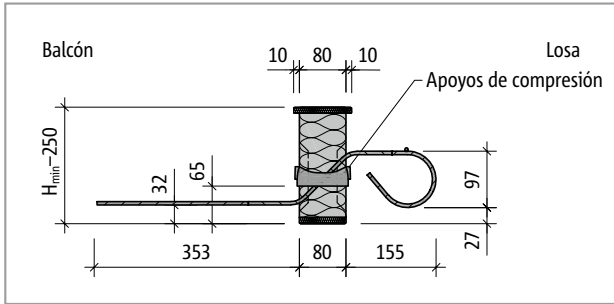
Schöck Isokorb® T tipo Q-V1 hasta Q-V5: Sección del producto
